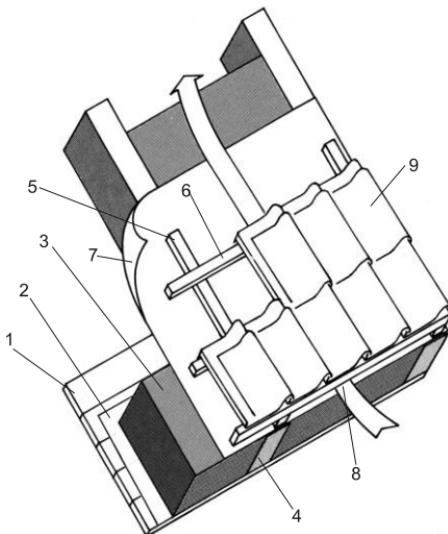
Теплоизоляция скатов крыши путем установки теплоизоляции между стропилами: 1 — внутренняя обшивка; 2 — парозащитная мембрана; 3 — теплоизоляционные плиты; 4 — стропила; 5 — вертикальная обрешетка; 6 — горизонтальная обрешетка; 7 — подкровельная гидроизоляция; 8 — вентилируемый зазор; 9 — кровельное покрытие (например, черепица)
